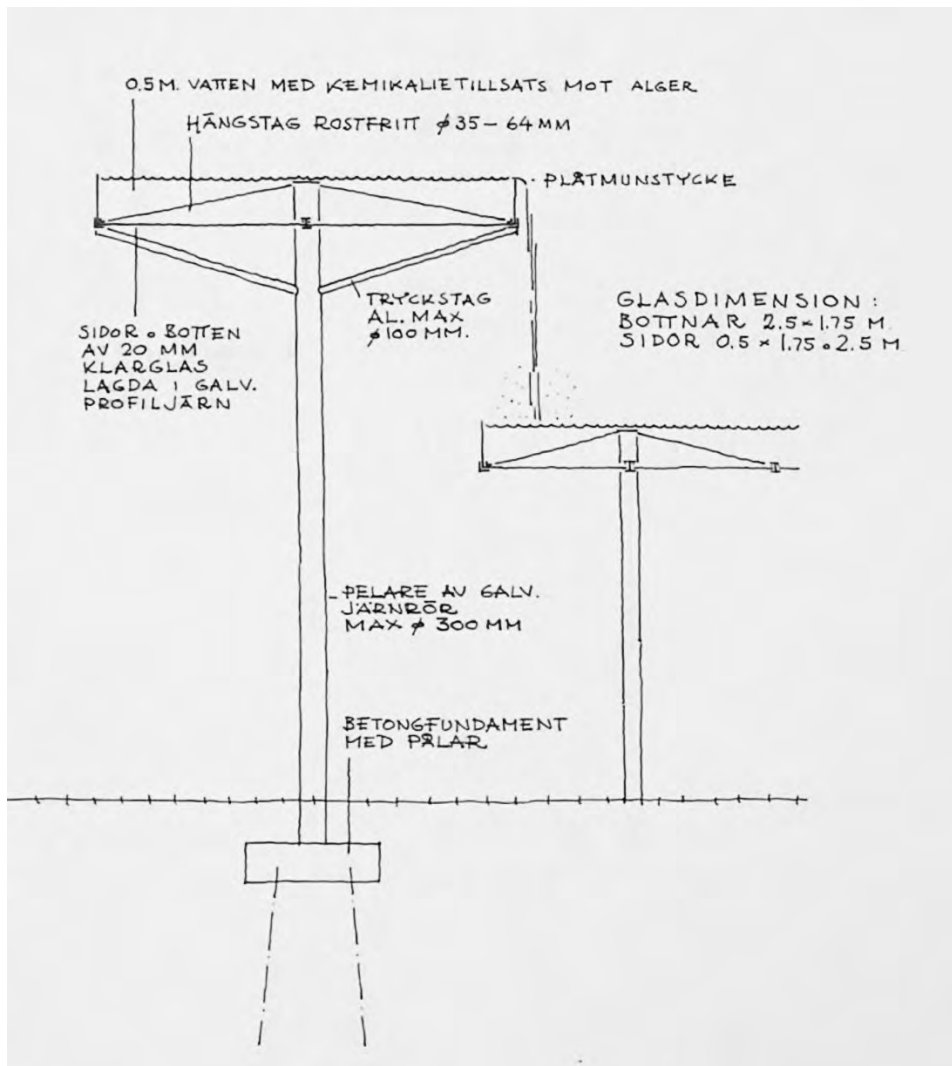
Panel 3. Detalle de la construcción. Los mástiles serían de tubo de acero galvanizado de 30 cm. de diámetro. Las varillas de 10 cm. de diámetro. El pilar recogería unos tensores redondos, de acero inoxidable de entre 35 y 64mm. de sección. Los vidrios, serían transparentes, de 20mm. de espesor, colocados sobre perfilera de acero. Los vidrios situados en los fondos de los vasos medirían inicialmente 2,5 x 1,75 metros. Se añadiría en el agua un componente químico contra el hiel. En cada vaso, en los puntos previstos, una plancha de metal se curvaría hacia fuera, rebajando el nivel del borde y dejaría escapar el agua en forma de cascada. A la derecha, el panel 3 completo.
